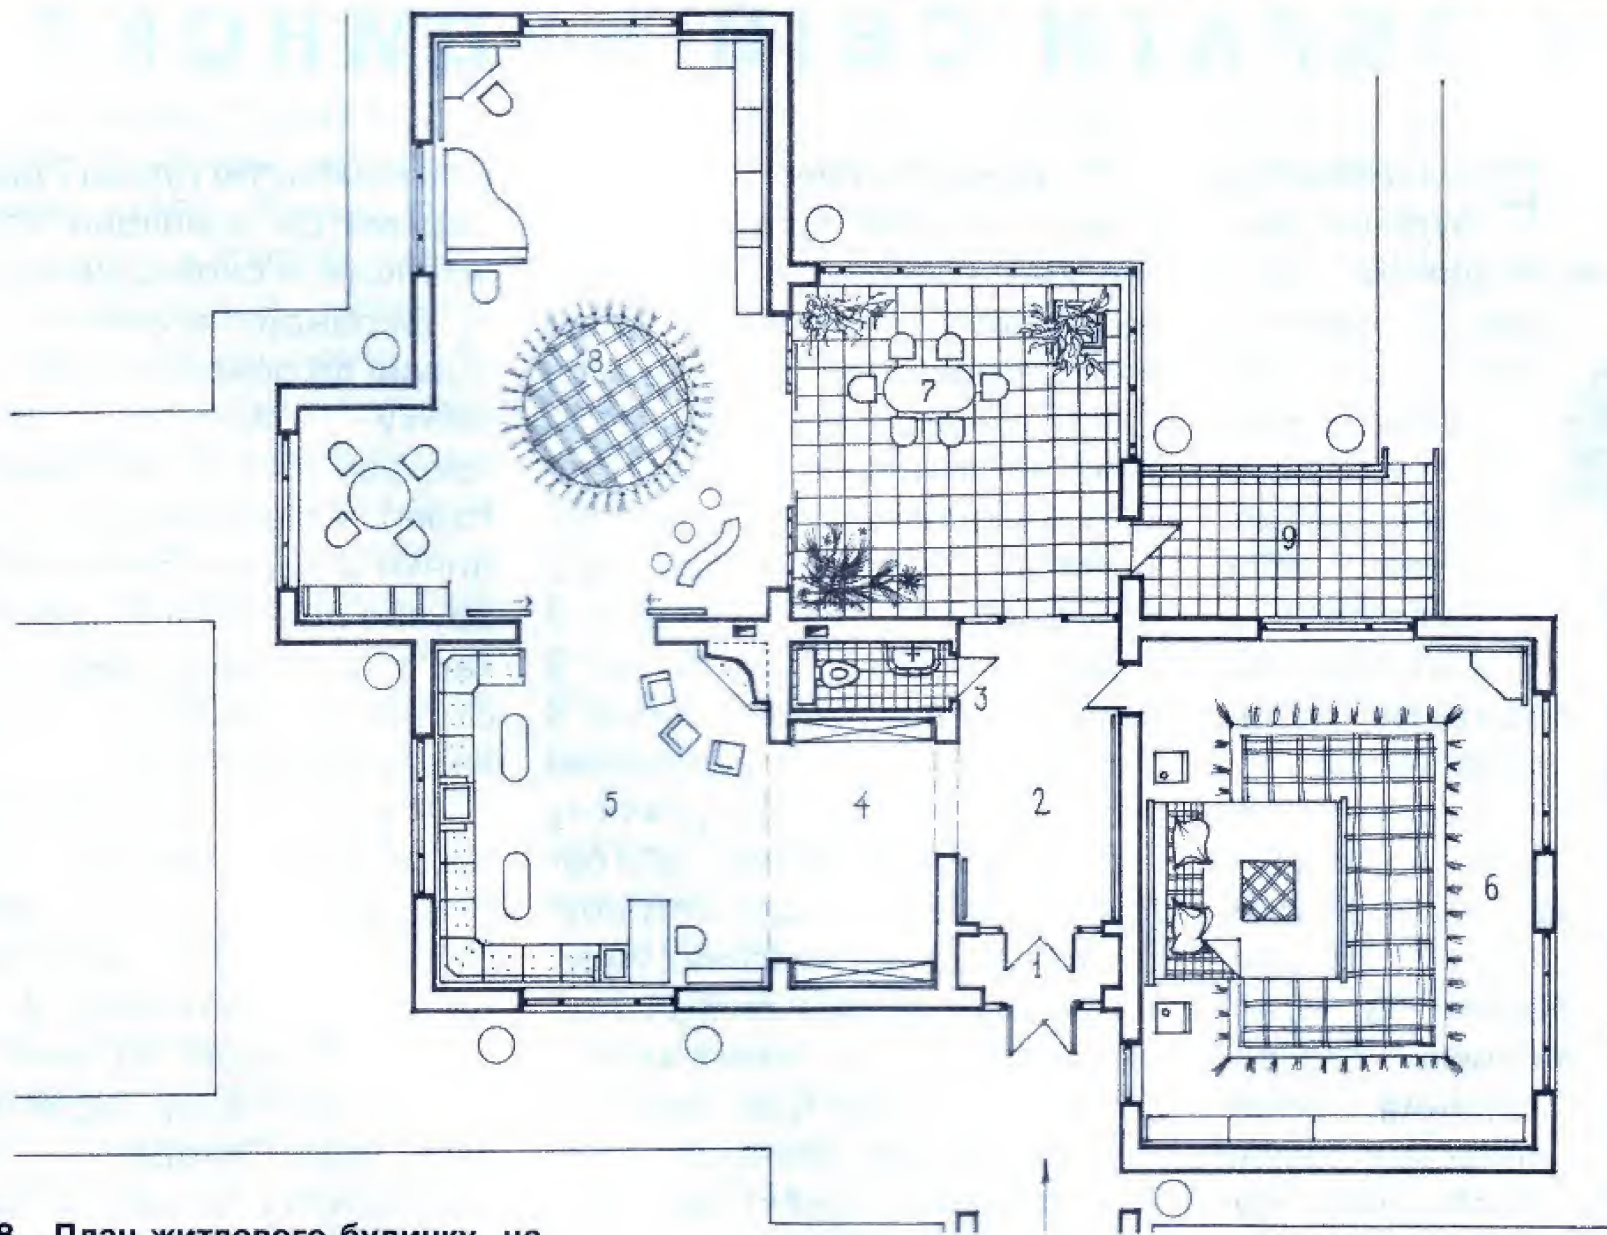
План житлового будинку на сім'ю з розгалуженою планувальною схемою в один поверх.
